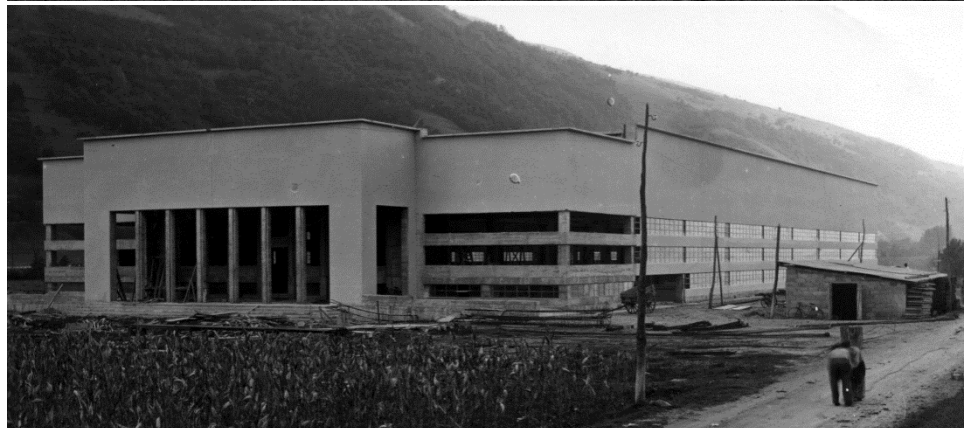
Pabellón primitivo en construcción desde el lateral oeste. Se está construyendo la estructura de cubierta. (AMV)
